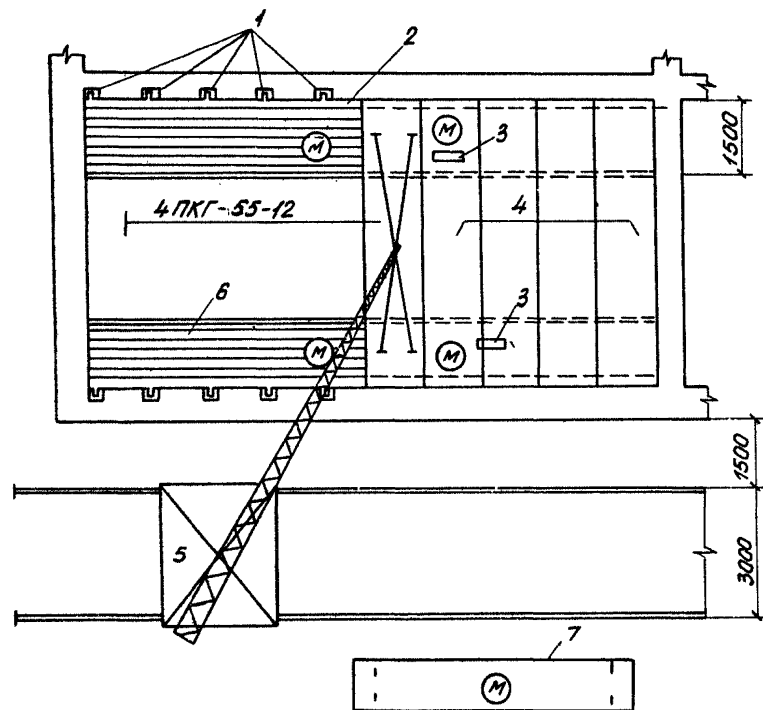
Общая схема организации работ по устройству участка перекрытия из плит ПКГ с опиранием на опорные гребенки МГО-2;
